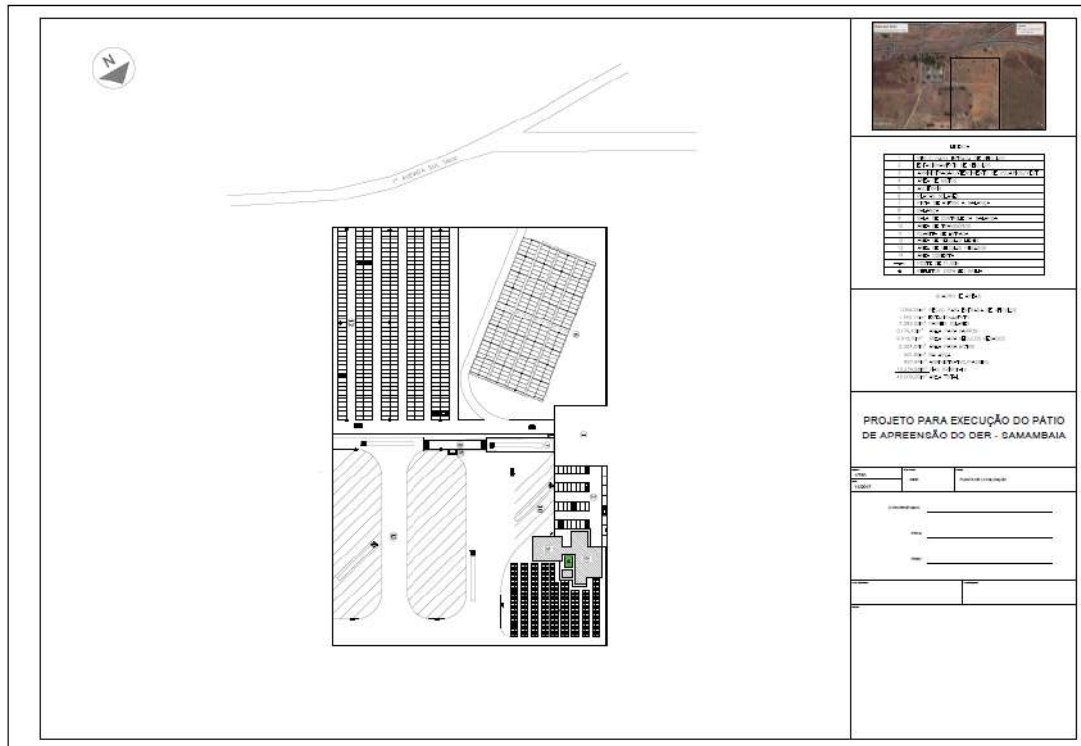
Planta de localização do Pátio Samambaia (Fonte: Elaboração própria)
